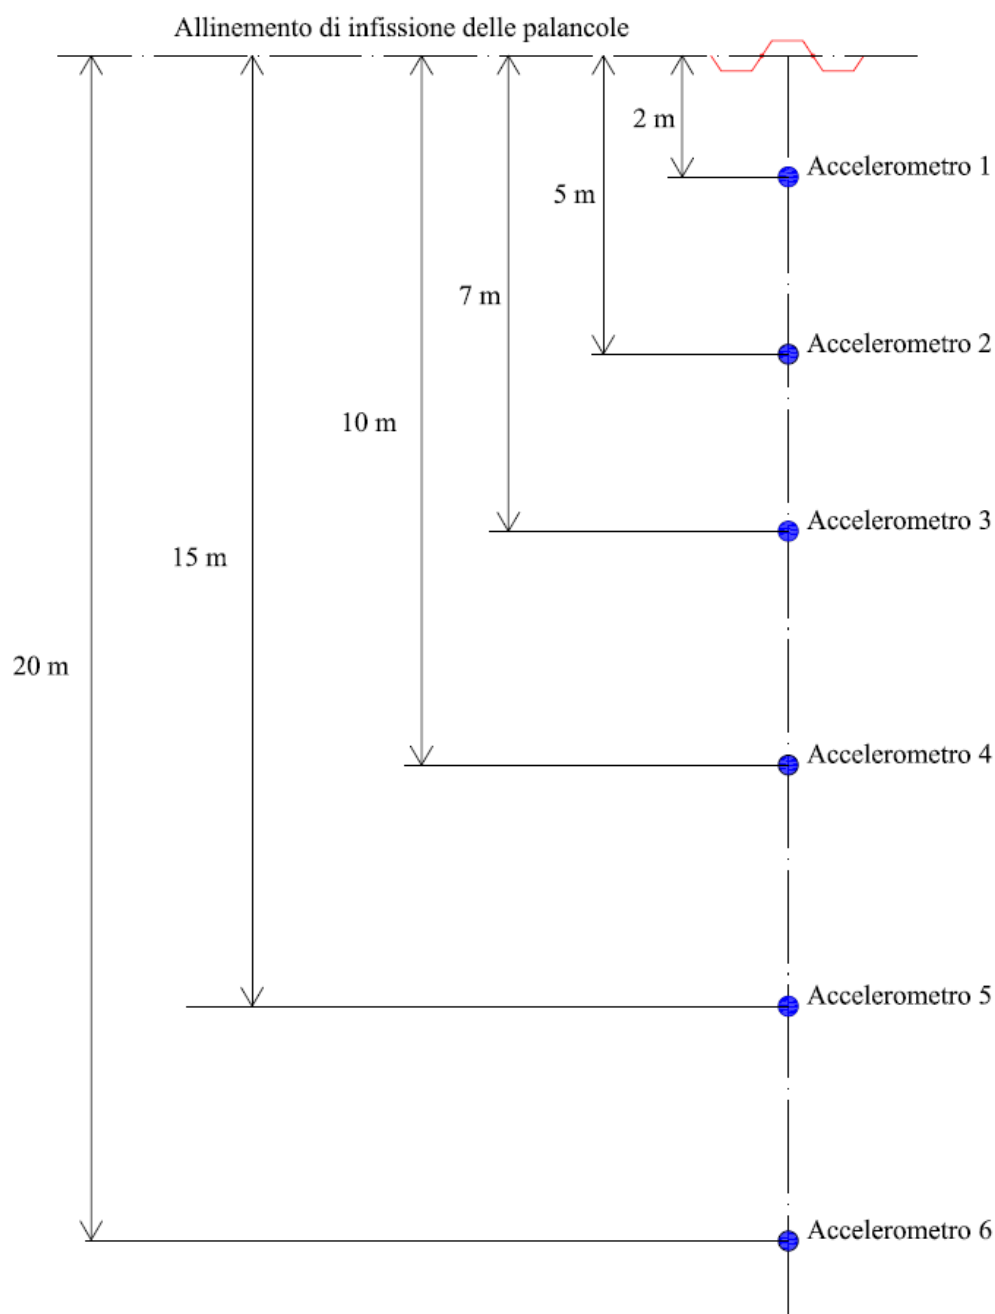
Posizionamento degli accelerometri rispetto le palancole da infiggere
